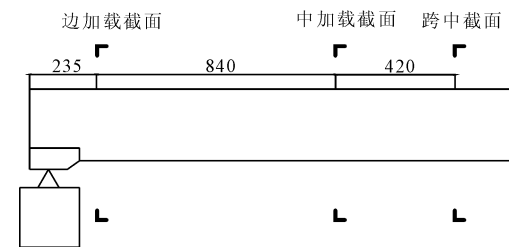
钢筋计和混凝土应变计测试截面(单位:cm)
